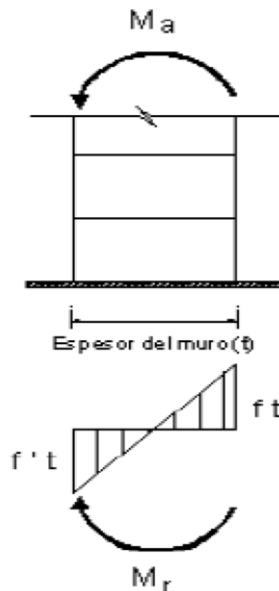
Momento Resistente en un muro de albañilería Fuente: Elaboración Propia
